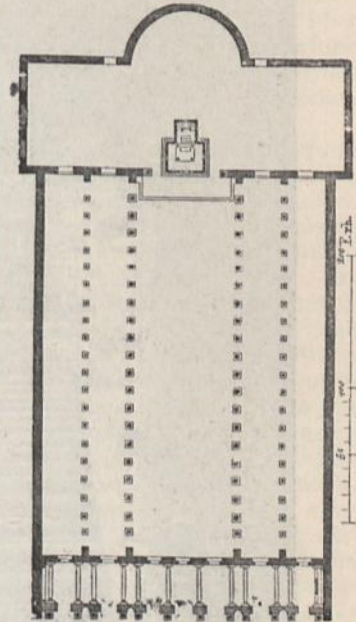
Grundriss von S. Paolo zu Rom.
